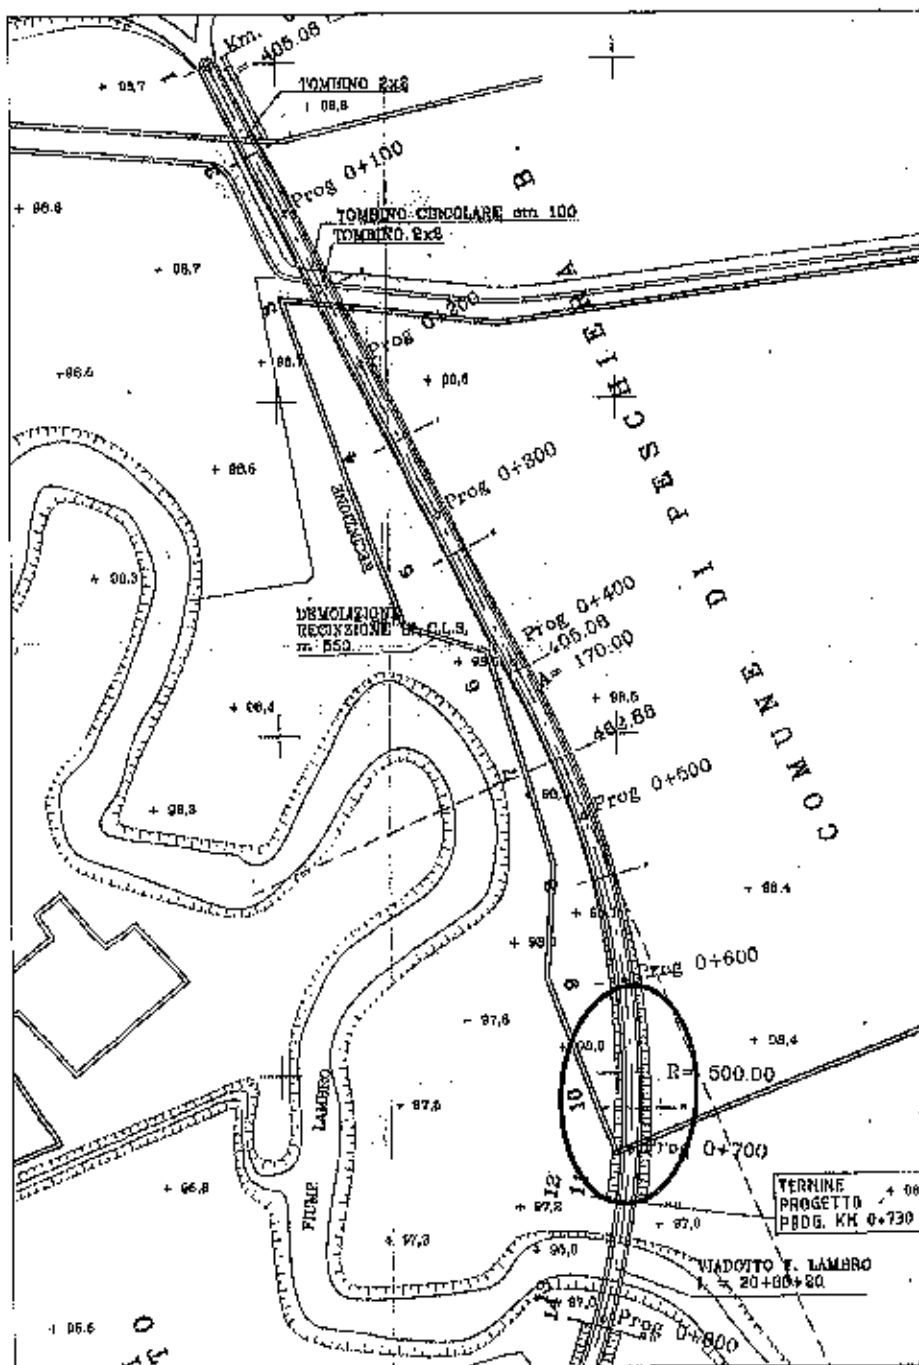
Planimetria di progetto con evidenziato in rosso il sito
